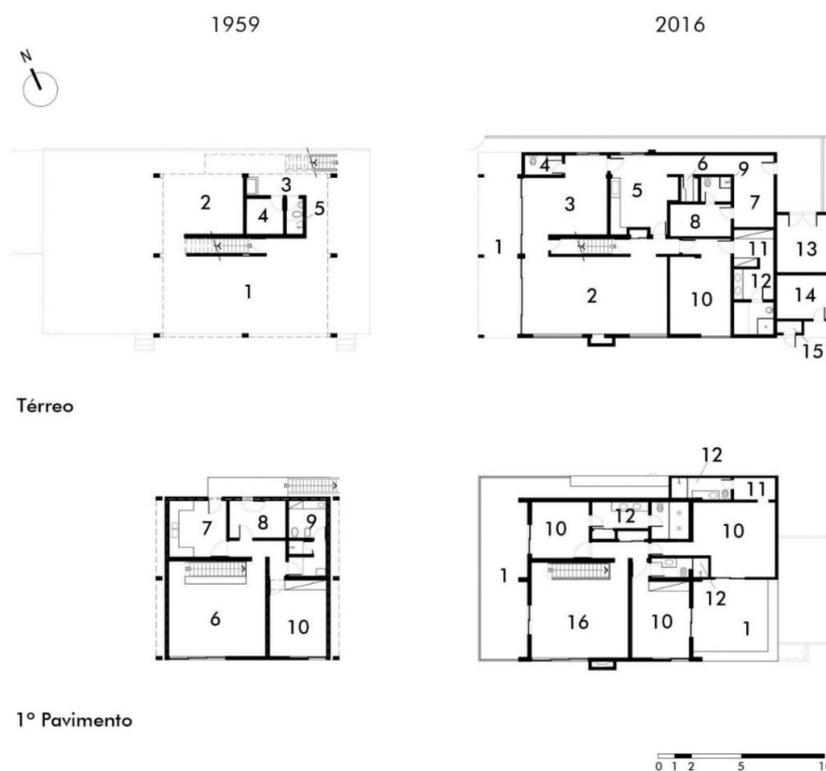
Plantas Baixas antes e depois das alterações.
